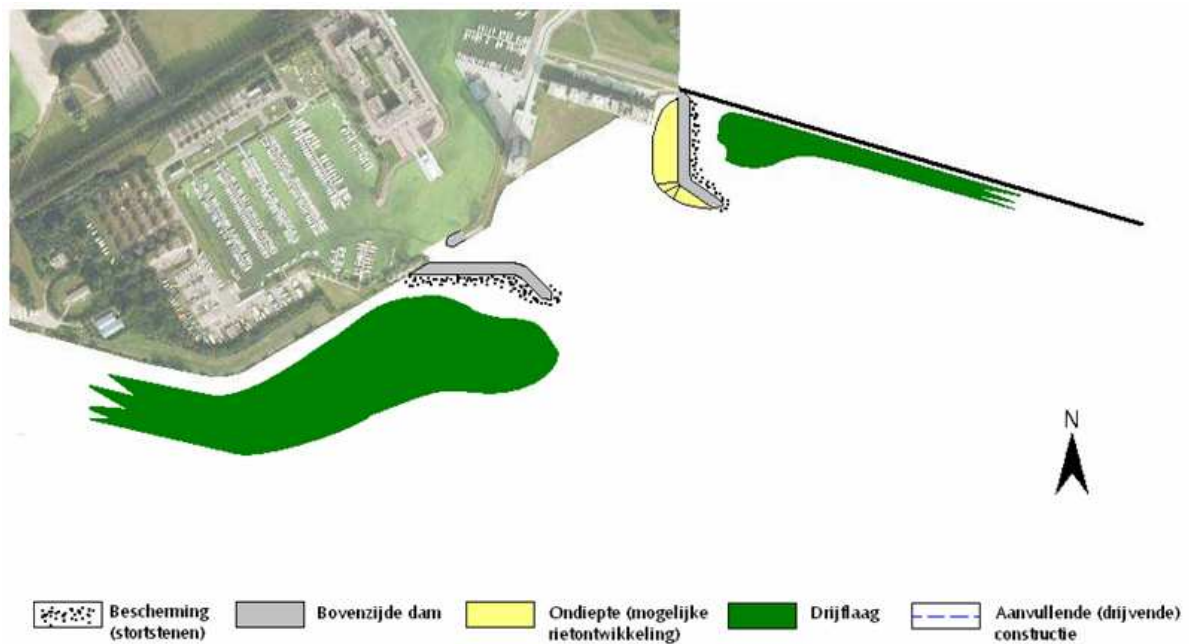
Variant 1 voor de bestrijding van algenoverlast in Almere-Haven.
